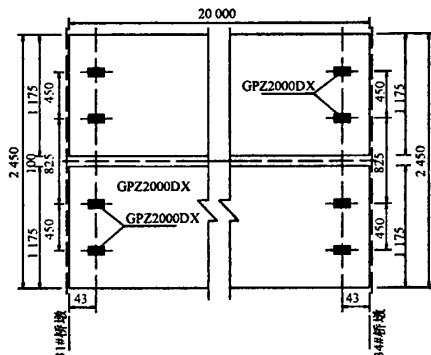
牛湾大桥主桥边墩盆式橡胶支座平面布置示意
